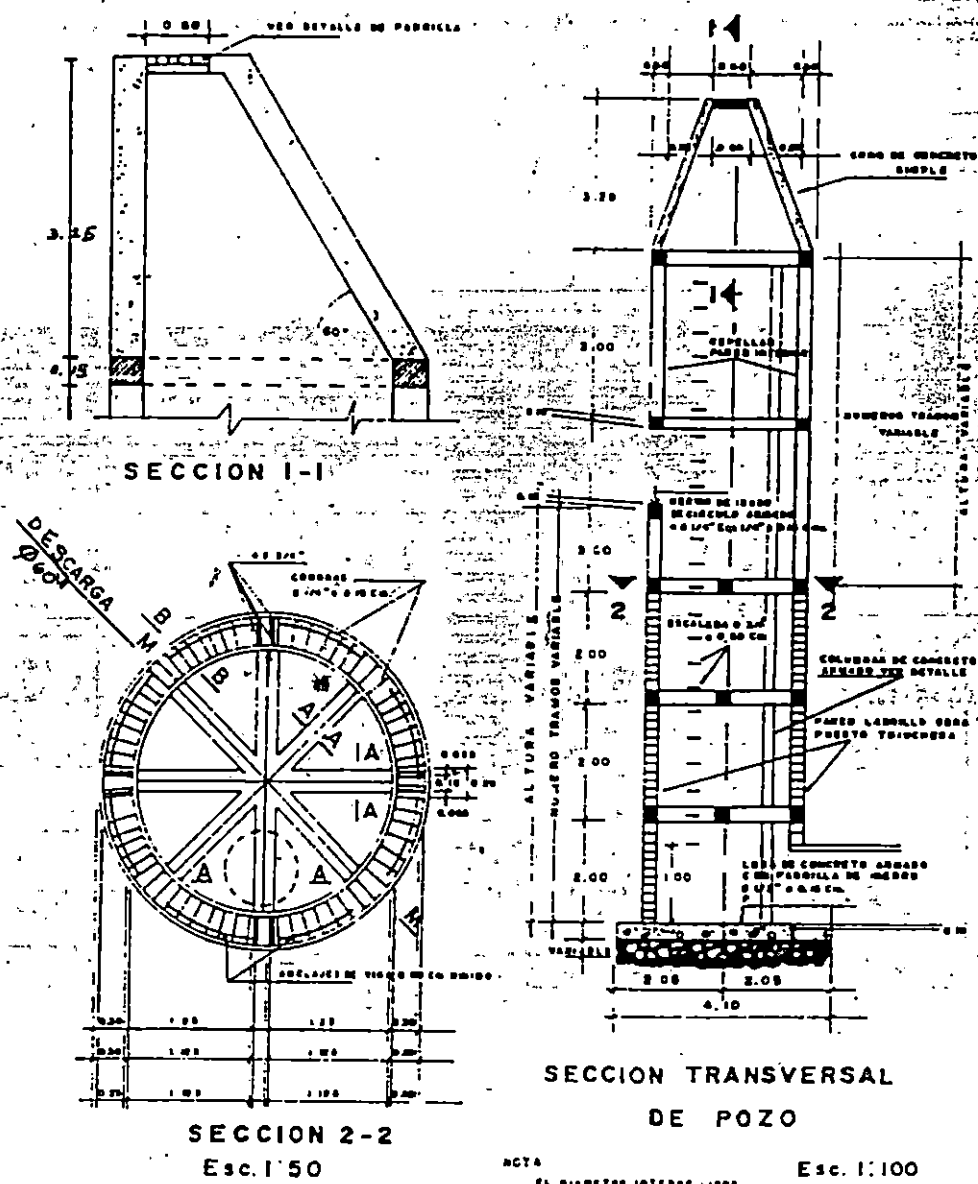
Detalle de Pozo Reforzado para Aguas Lluvias
